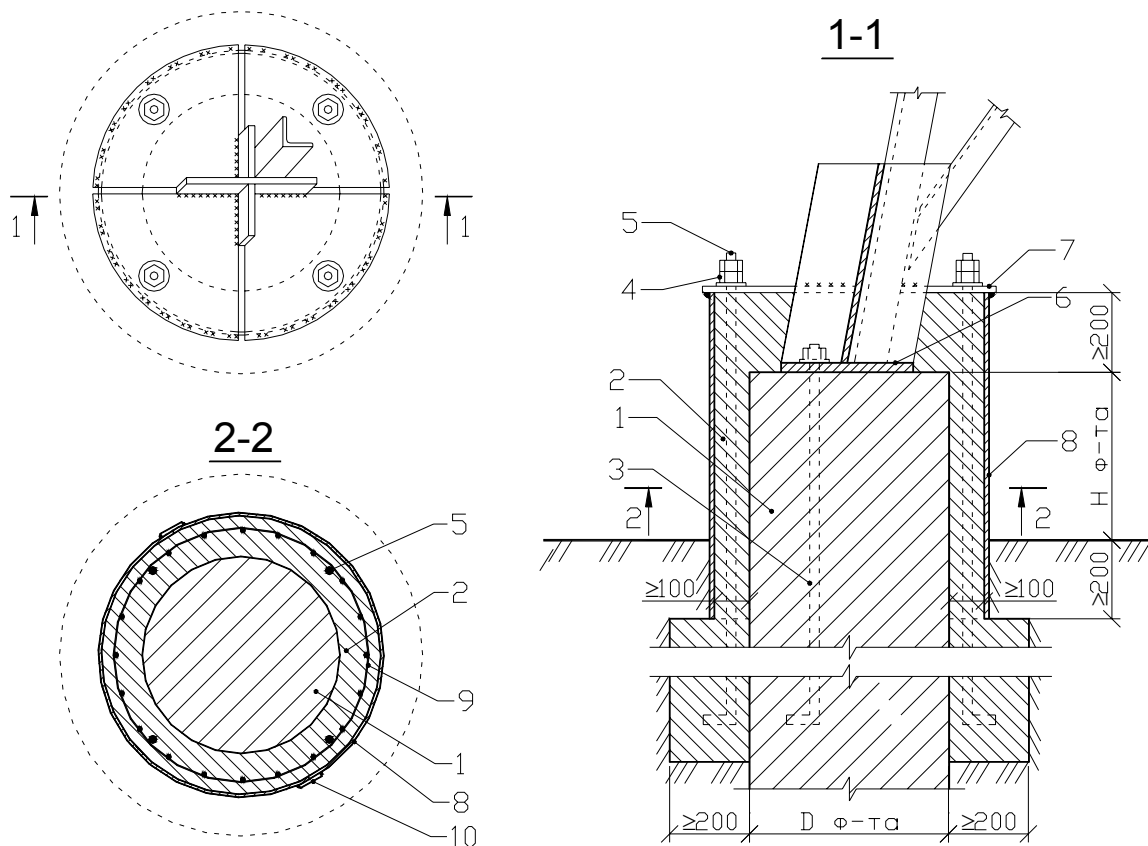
Усиление элементов нижних панелей стоек и узла опирания конструкции на фундамент: 1 — существующий фундамент; 2 — новый фундамент; 3 — существующий анкерный болт; 4 — гайки с шайбами; 5 — новый анкерный болт; 6 — поврежденные элементы конструкции базы (башмака); 7 — анкерная пластина; 8 — стальная обойма; 9 — сетка; 10 — стальные накладки для крепления обоймы.
